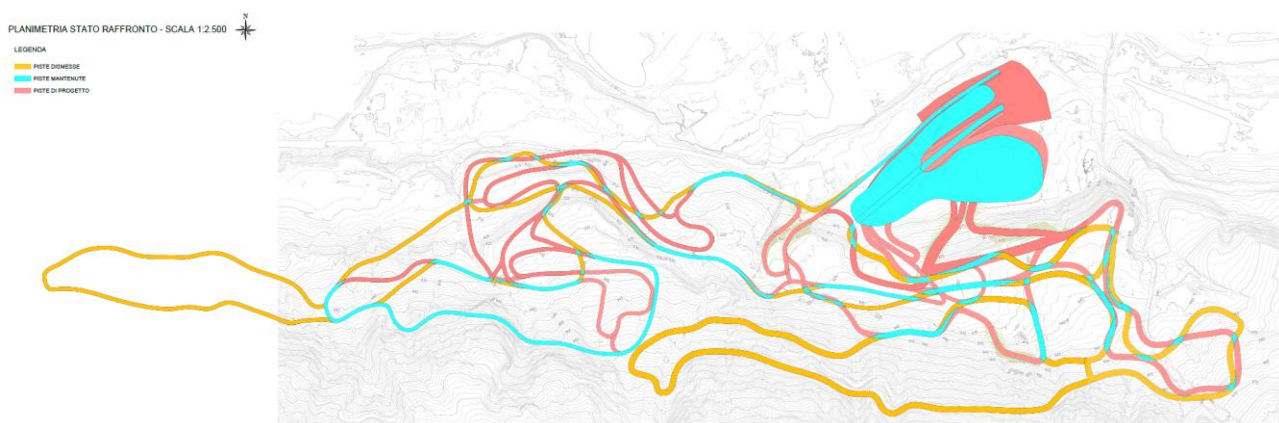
Planimetria di raffronto scala a vista (vedasi tavola E.T.311.002)
